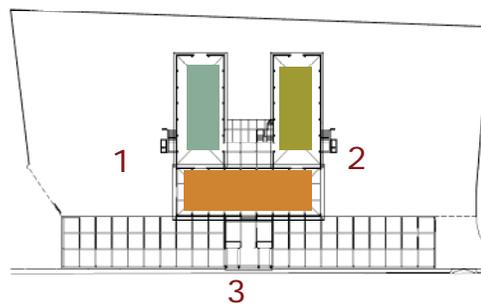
PLANTA ESQUEMÁTICA PRIMER NIVEL: 1,2,3 indican los accesos principales del Mercado desde el nivel de calle.
